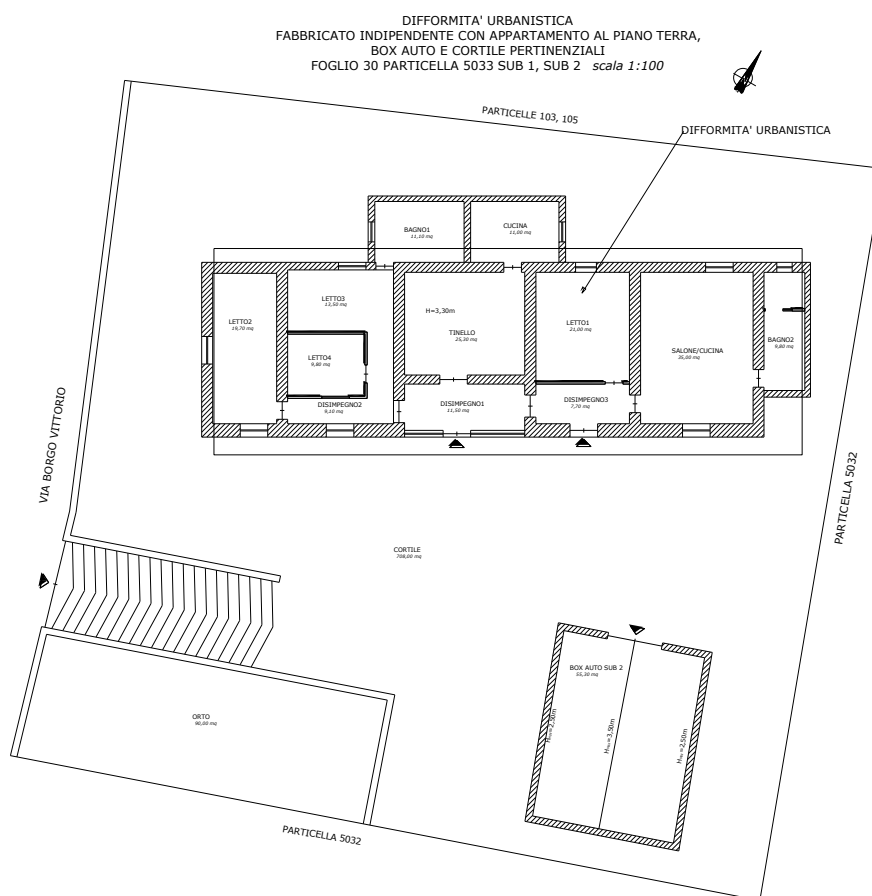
planimetria con le difformità urbanistiche del lotto unico
